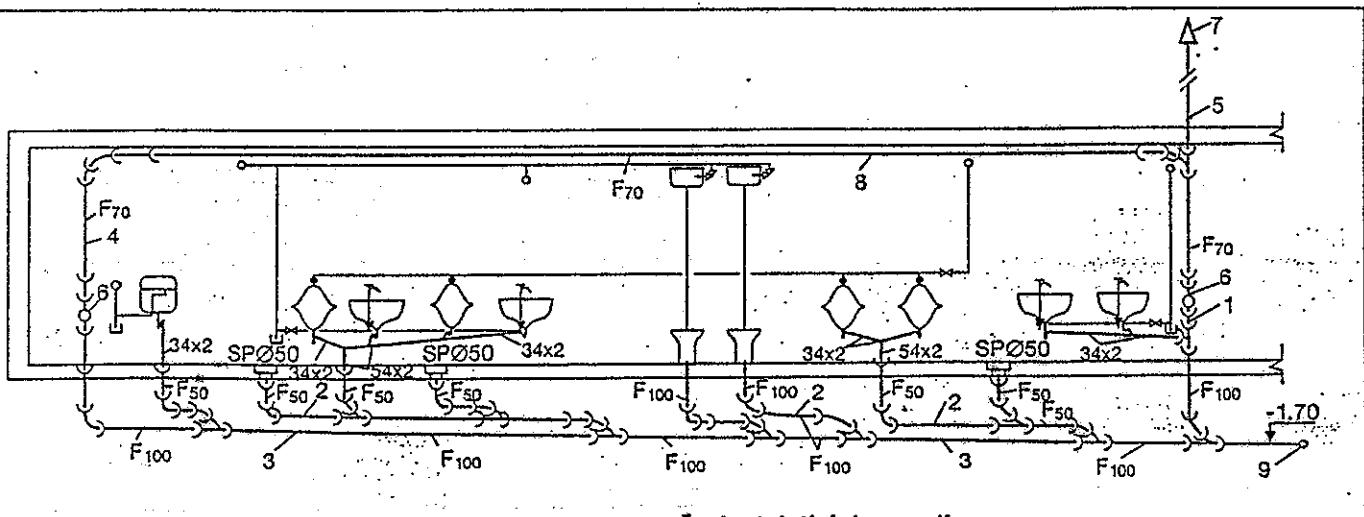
Ventilarea secundară a instalației de canalizare:
